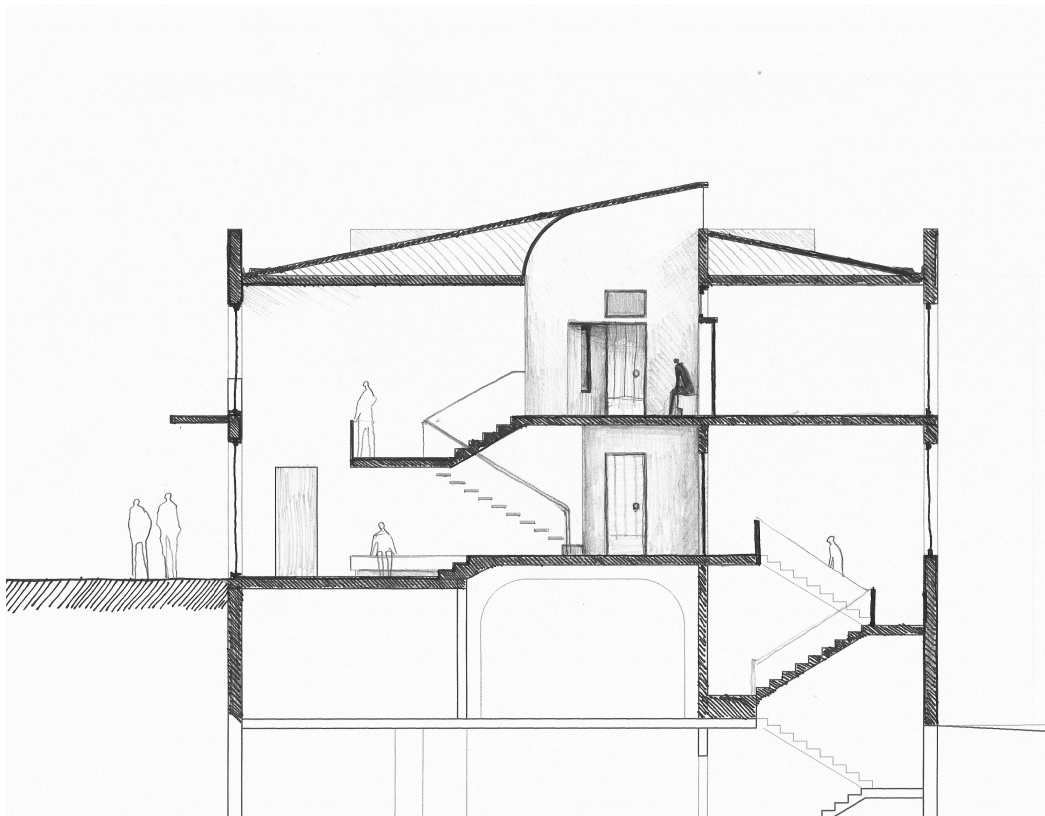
Corte Átrio e Fachada – Desenho do autor.
